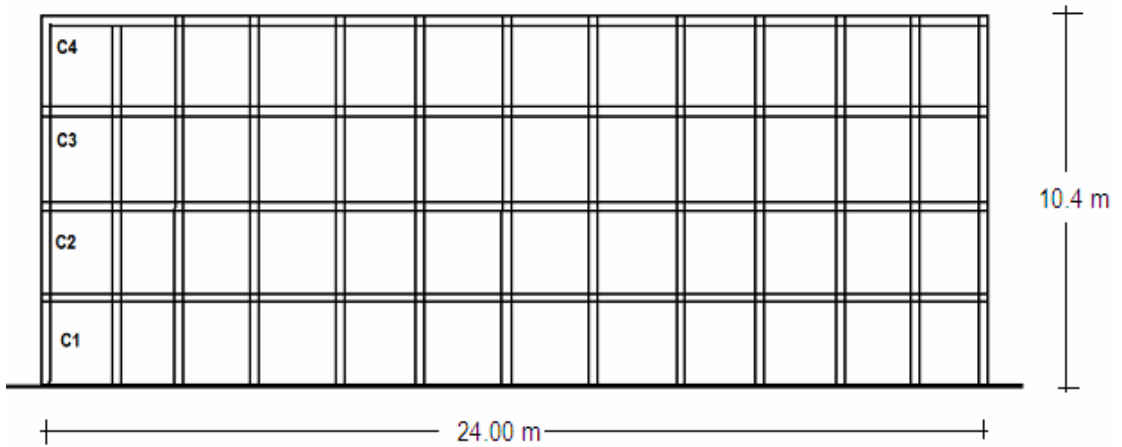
Anexo 8. Elevación estructural frontal de edificio
